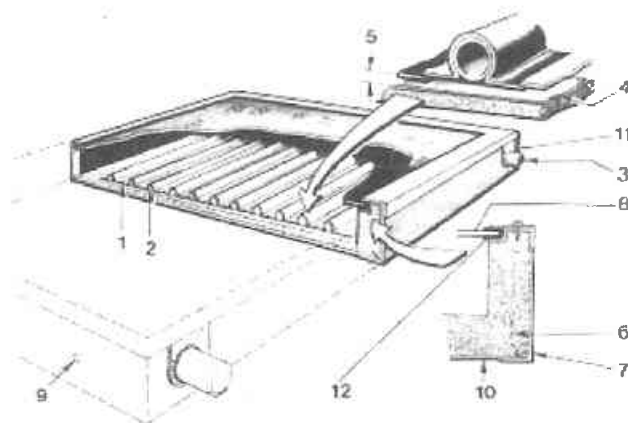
Detalle de un colector solar plano: 1, placa de absorción; 2, rejilla de tuberías de cobre; 3, conexión extrema de tubería; 4, hoja de aluminio; 5, cámara de aire; 6, aislante; 7, estructura exterior del colector (bastidor); 8, lámina de vidrio; 9, taladro para sujeción atornillada; 10, fondo del colector; 11, escuadra de refuerzo; 12, junta de caucho neopreno.
